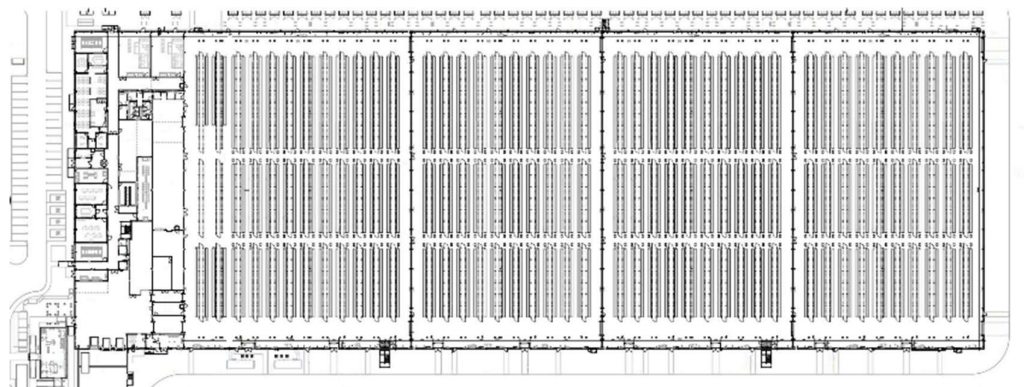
Extrait du plan du hall d'hébergement des serveurs informatiques
